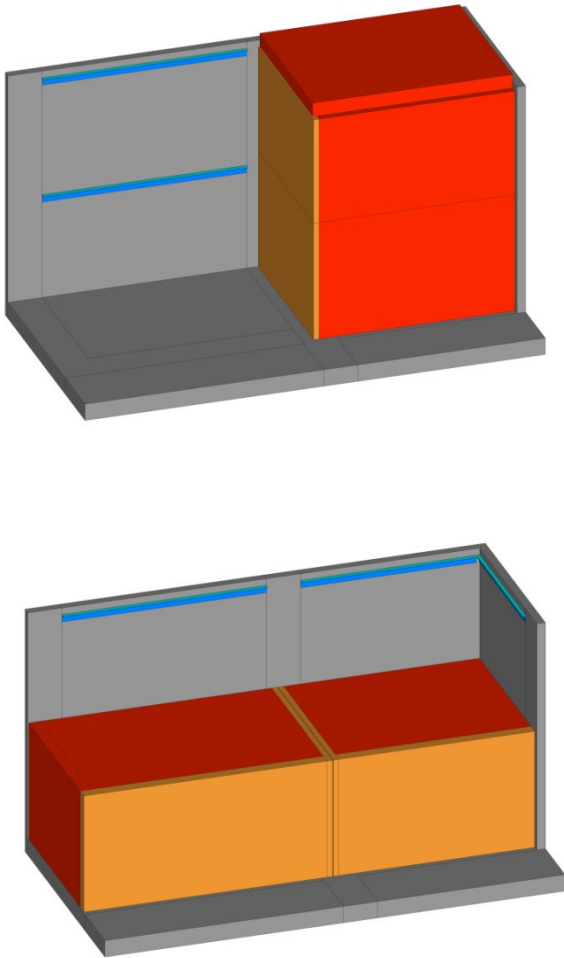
Dreidimensionale Prinzipdarstellung der Geometrie des Leichtbauprüfstands mit der massiven Grundkonstruktion und den eingebauten Prüfkörpern. Der obere Bildteil zeigt den Prüfaufbau für die Messung der vertikalen Schallübertragung, der untere Bildteil zeigt den Prüfaufbau für die Messung der horizontalen Schallübertragung. Die massiven Bauteile sind grau, die leichten Prüfkörper ockerfarben, die Defaultelemente sind rot dargestellt.
